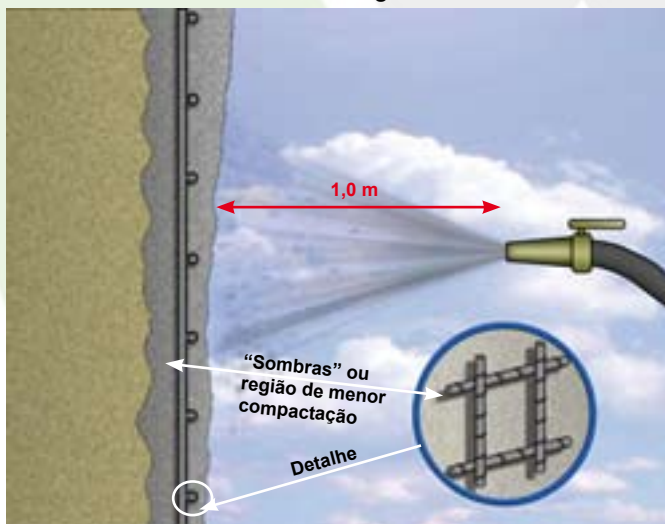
Detalhe das "sombras" na aplicação do concreto
